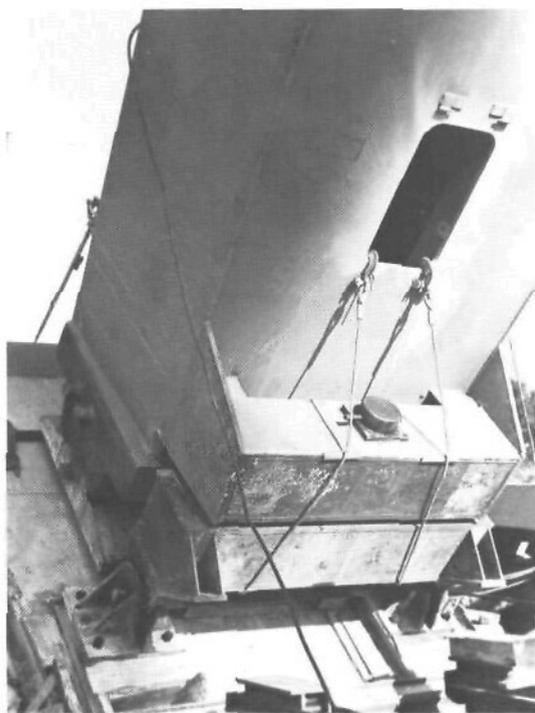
Articulation provisoire d'une béquille. La béquille peut tourner autour de deux axes de rotation, visibles sur la photo.
